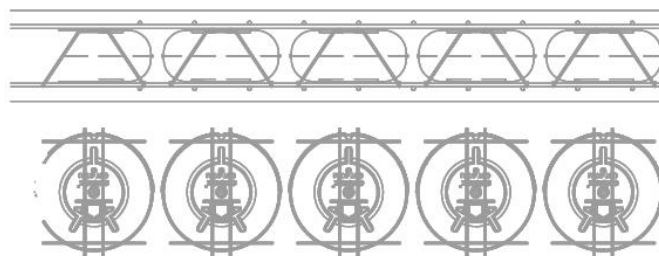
Disposição construtiva em alçado e em planta dos moldes de aligeiramento Cobiax
